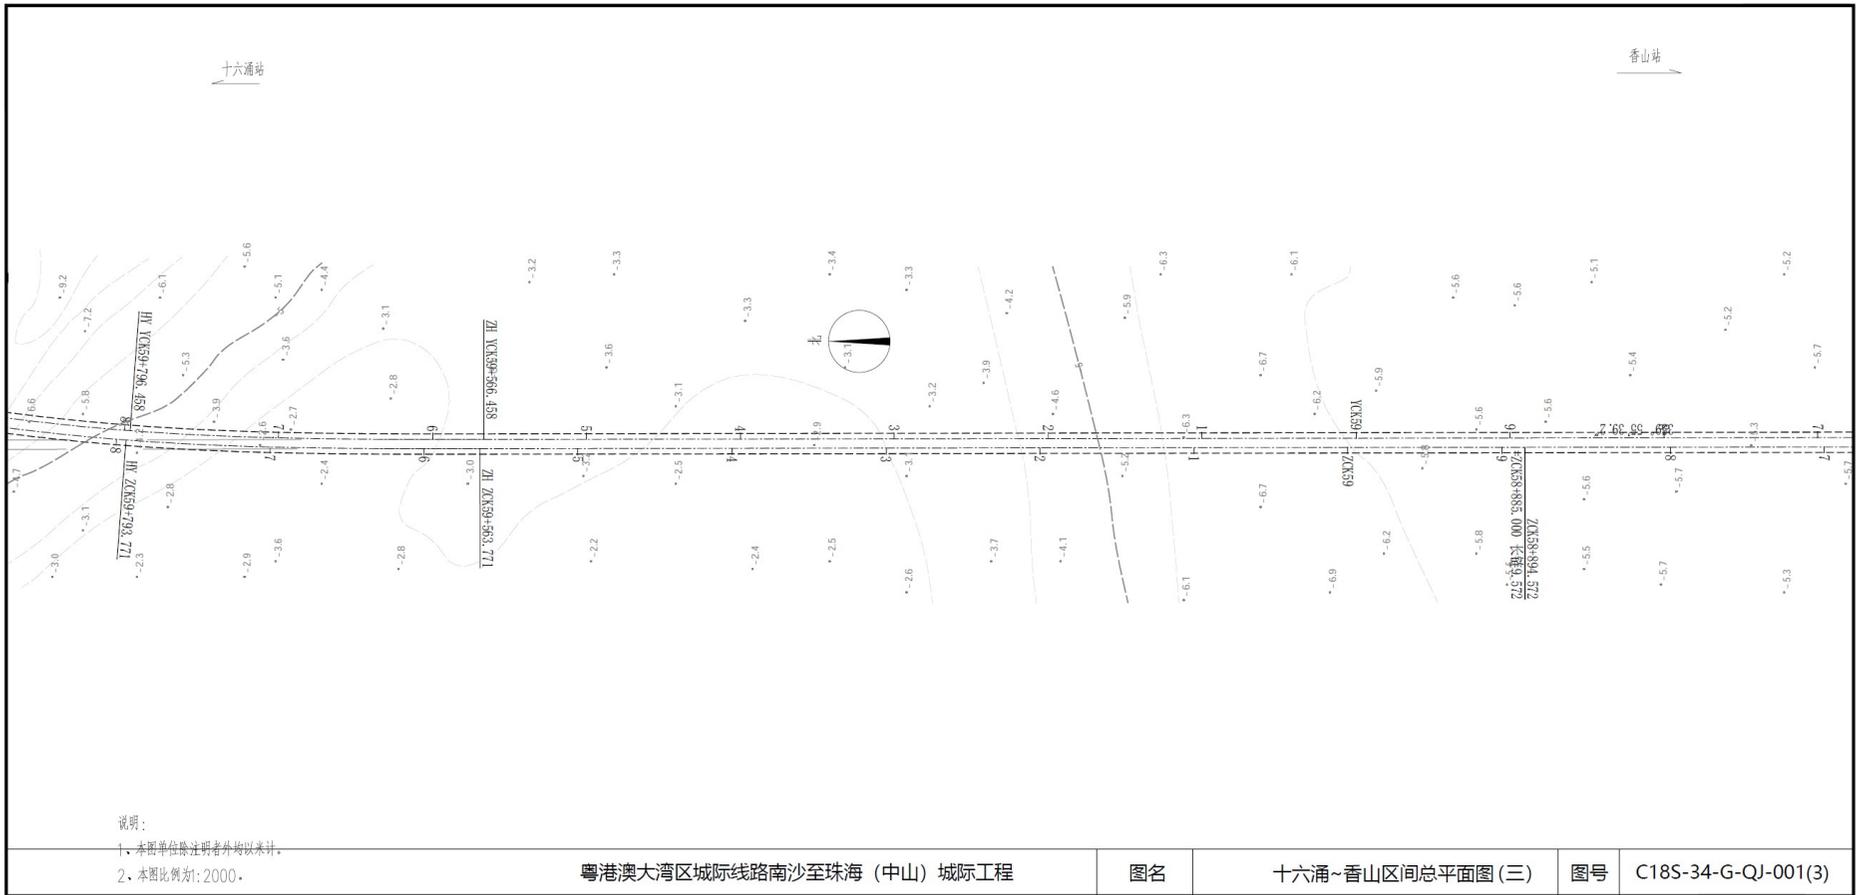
线路平面图（十六涌至香山段涉海工程段）
